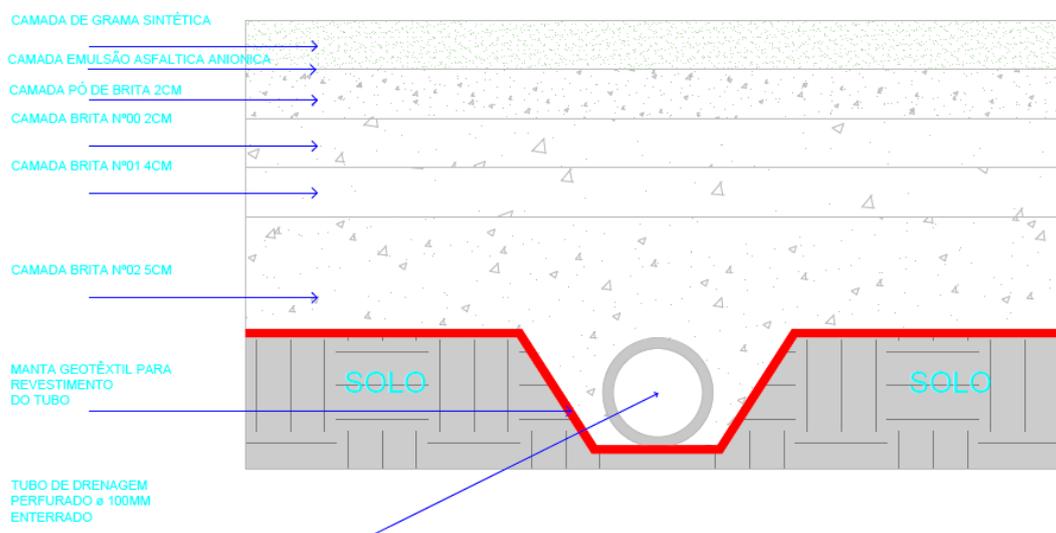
CORTE ESQUEMÁTICO– BASE DRENANTE, DETALHE 08 PRANCHA 07/08
